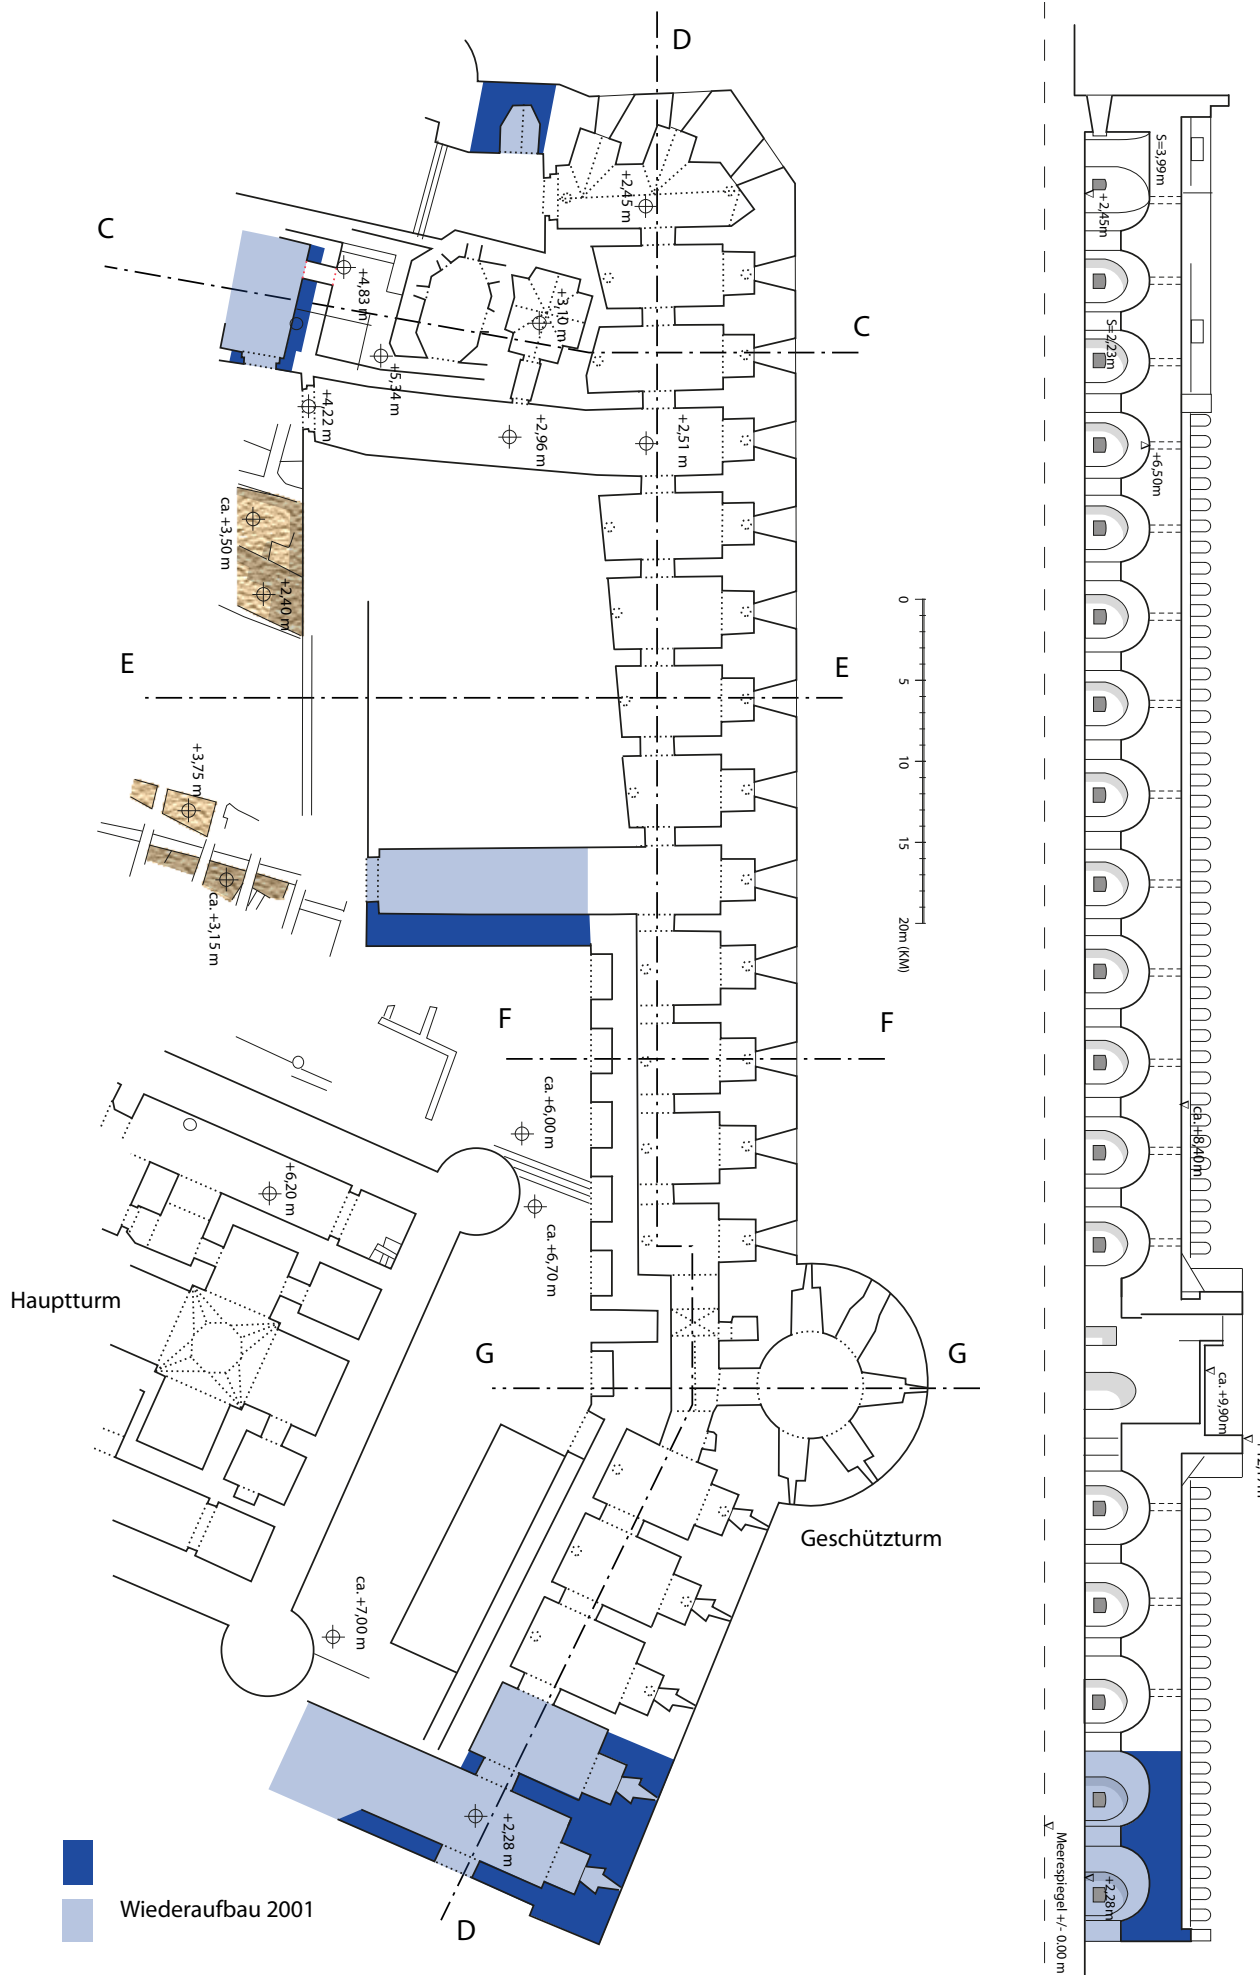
Die nördliche Wehrmauer: Grundriss Kasematten und Längsschnitt D-D.
